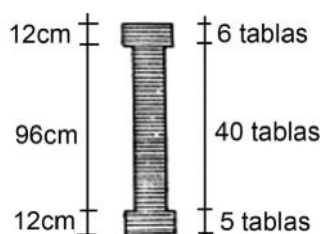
Viga de 1,2 m acoplada mediante adhesivos.
